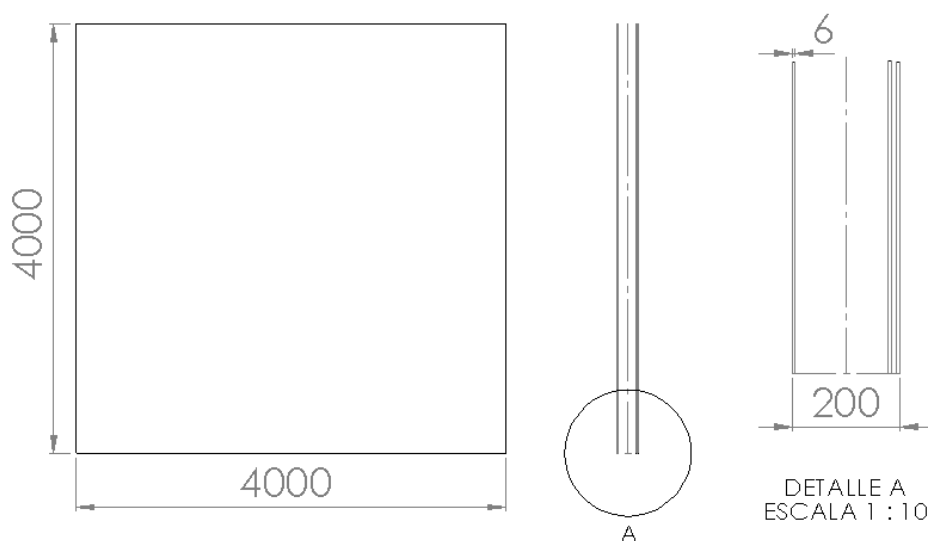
Geometría Fachada (Solidworks)
